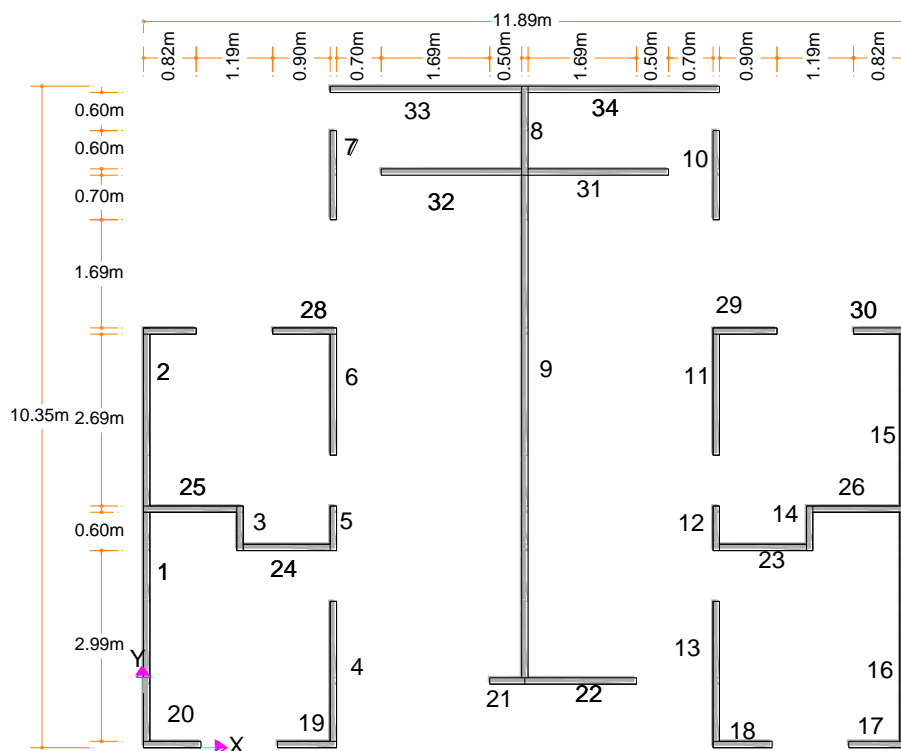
Planta de la estructura de concreto reforzado y mampostería confinada.
